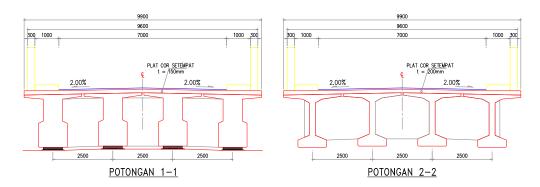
Denah Type Buld Tee Girder Perencanaan Jembatan Sei Rakyat
